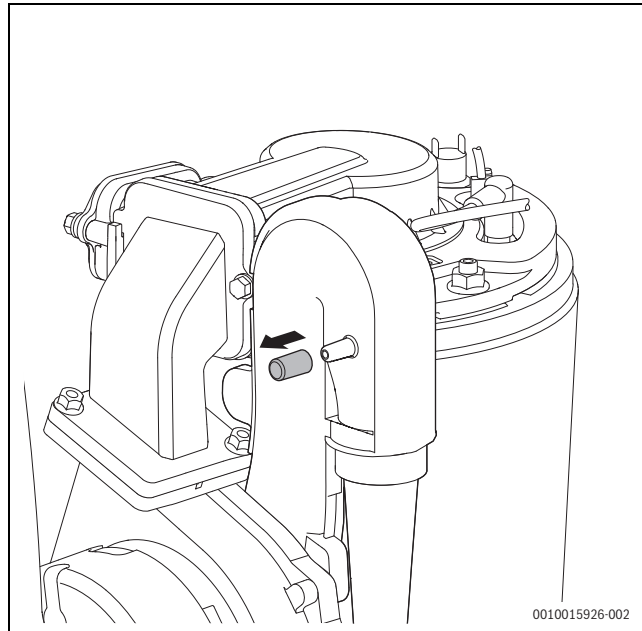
Tubulure de mesure sur le dispositif de mélange
